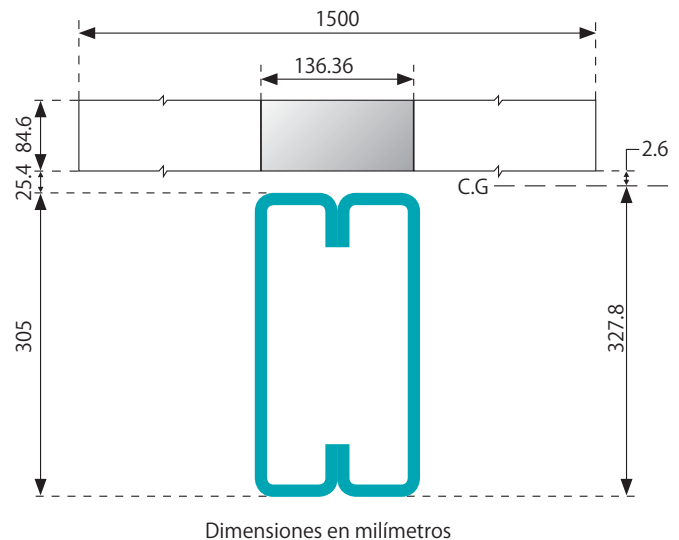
Sección transversal vigueta PERFIL-ACESCO con tablero metálico en METALDECK 2" (0.75mm). Losa en concreto de 110mm de espesor
